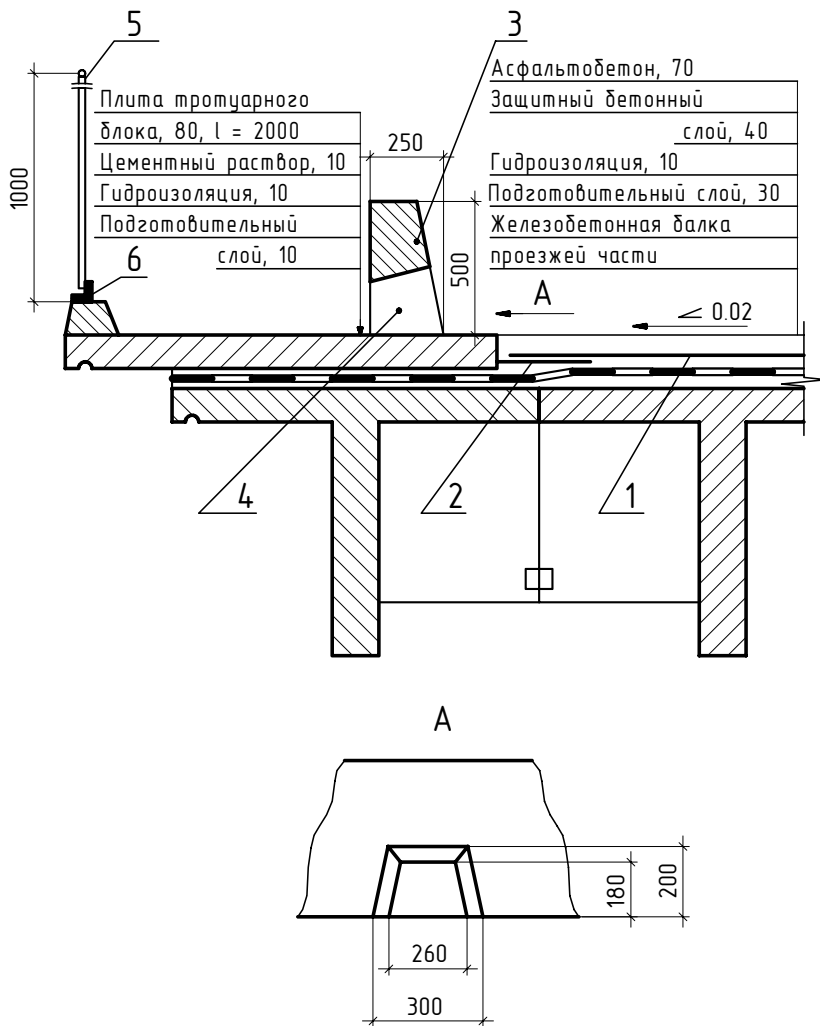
Тротуарный свешивающийся блок и крепление его к асфальтобетонной проезжей части:
